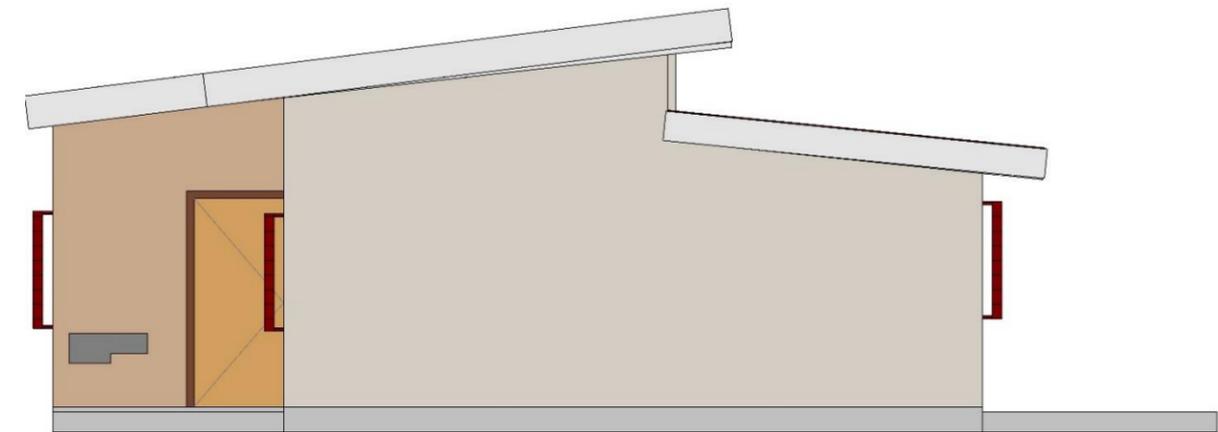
Fachada Sur - Vivienda Modelo C-12.
